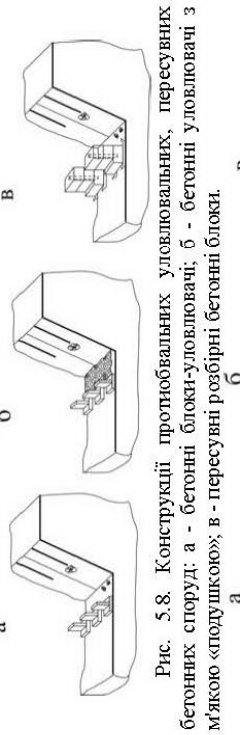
Конструкції протиобвальних уловляльних, пересувних бетонних споруд: а - бетонні блоки-уловлячі; б - бетонні уловлячі з м'якою «подошкою»; в - пересувні розбірні бетонні блоки.
